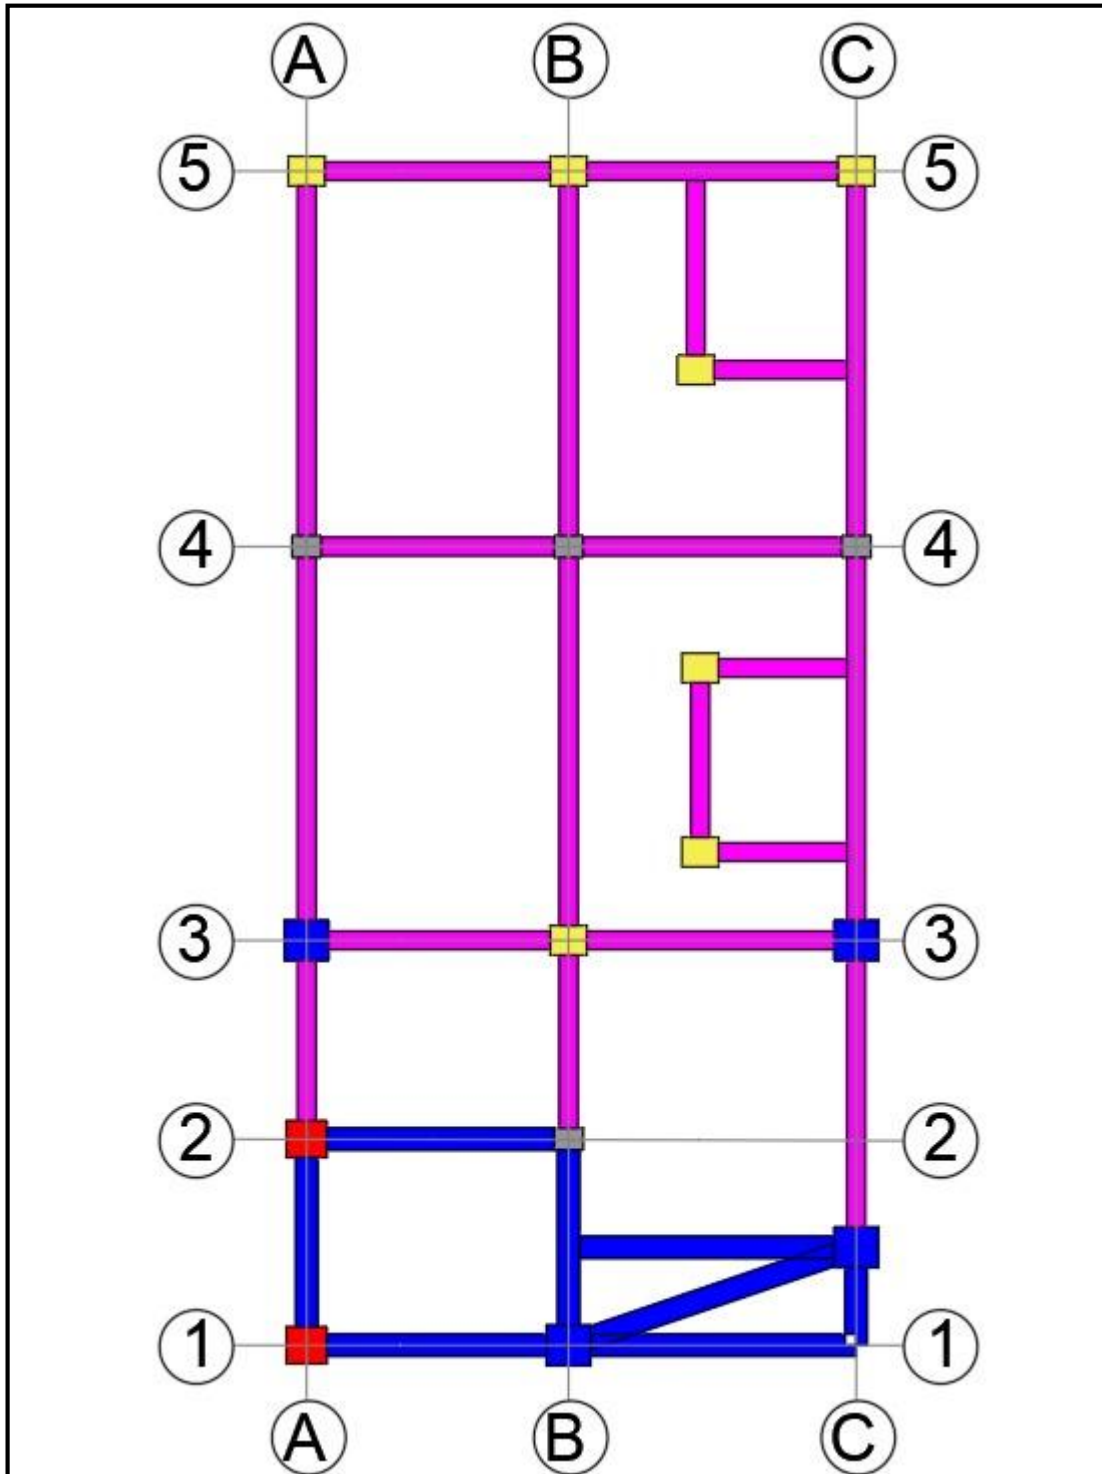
Distribución de vigas y columnas piso 4. Fuente: Nicolás Pozo
